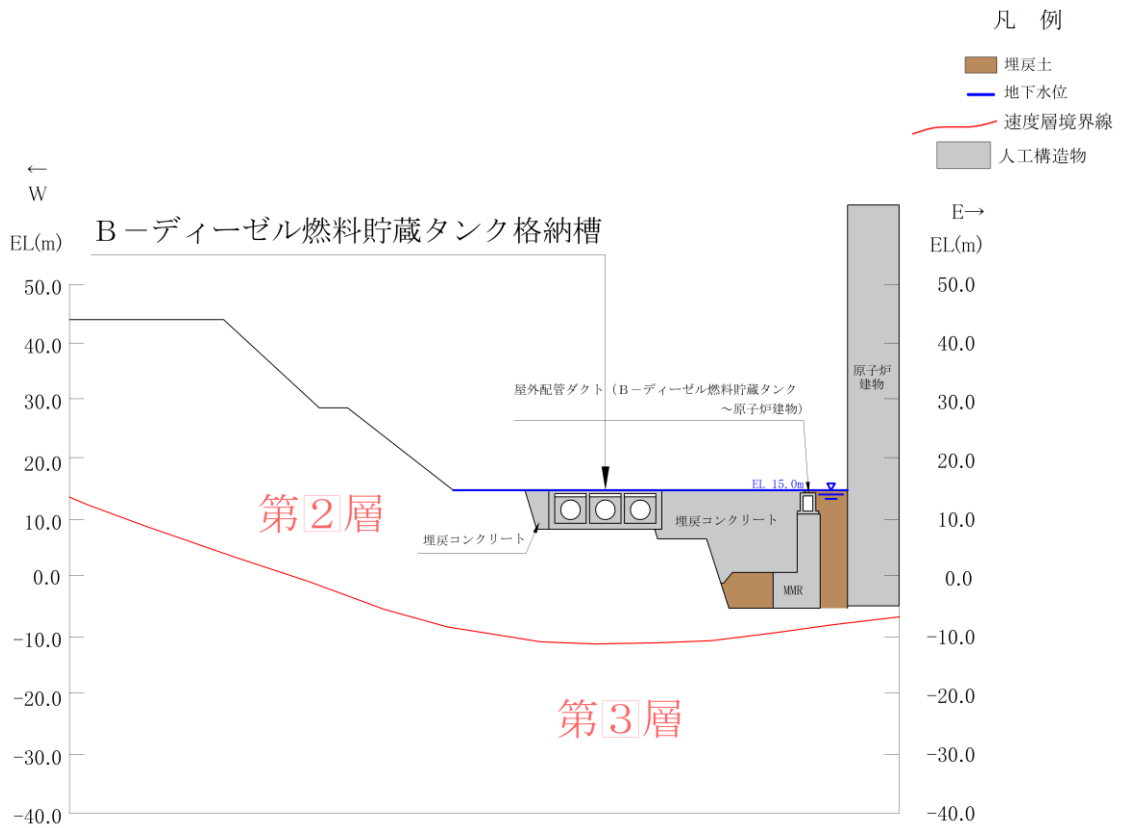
B-ディーゼル燃料貯蔵タンク格納槽 評価対象断面図 (A-A断面)
